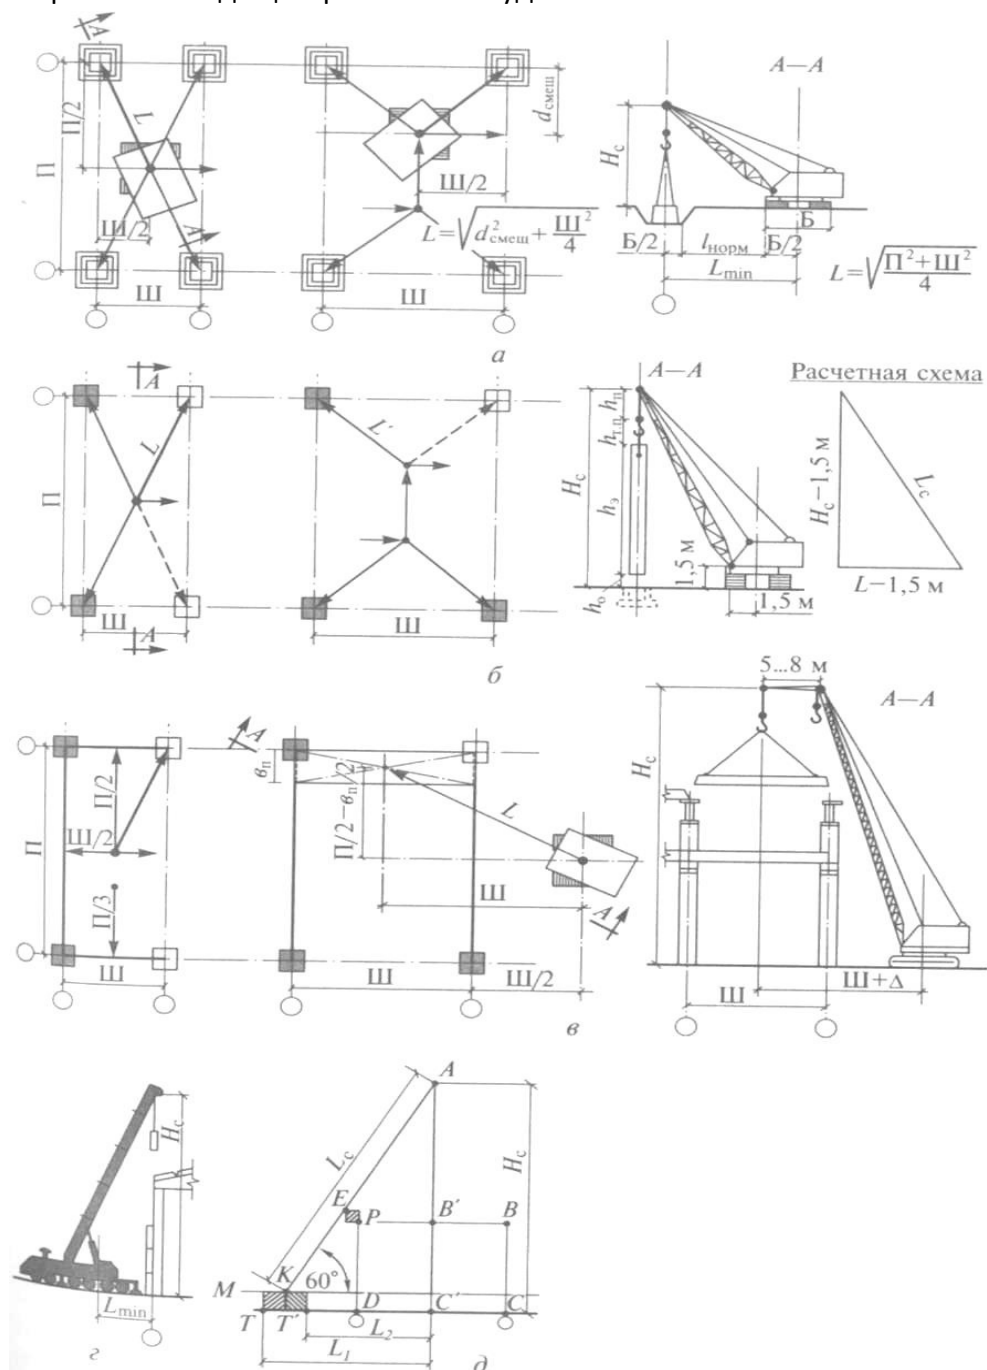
Определение основных характеристик крана графическим методом при монтаже: а — фундаментов; б — колонн; в — ферм, подкрановых балок и плит покрытия; г — стеновых панелей; д — упрощенный способ; Ш — шаг; П — величина пролета; $d_{\text{смещ}}$ — длина смещения крана; $L_{\text{норм}}$ — расстояние от опоры до бровки
